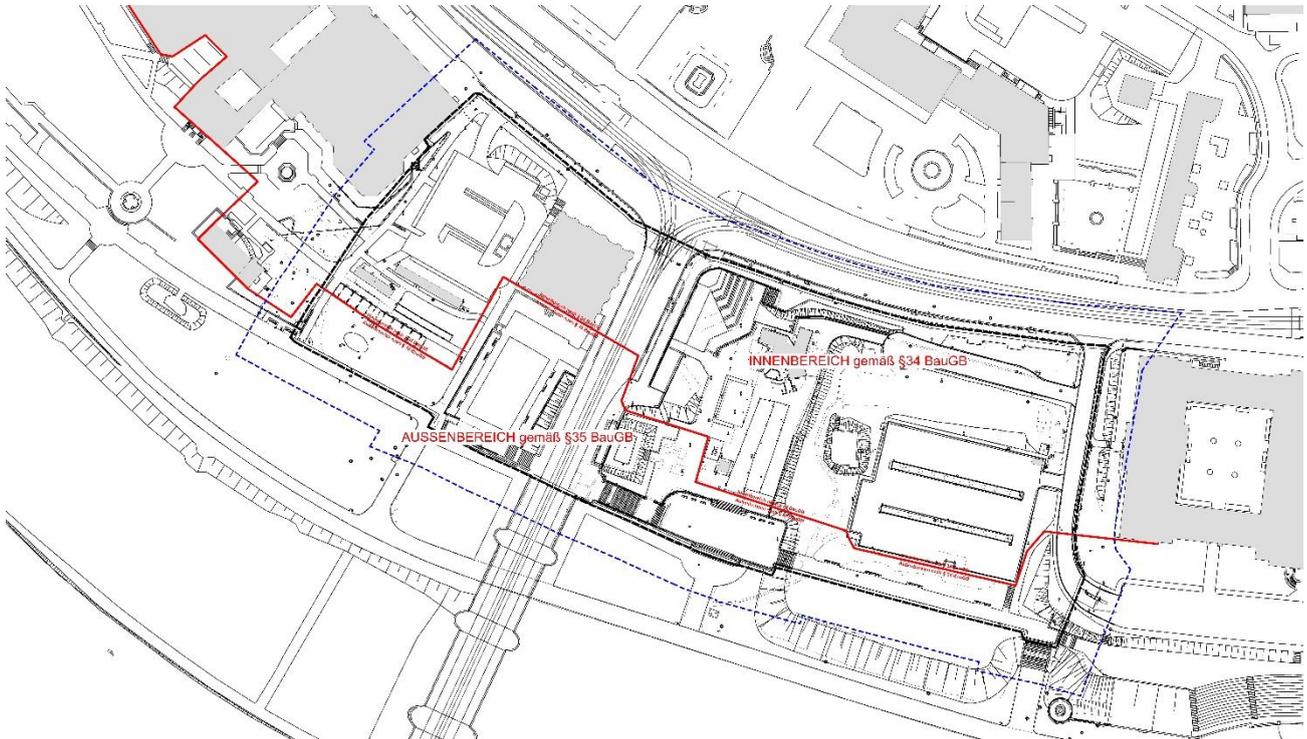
Abgrenzung Innenbereich gemäß §34 BauGB und Außenbereich gemäß §35 BauGB (rote Linie), erweiterter Betrachtungsraum (blaue Linie)
